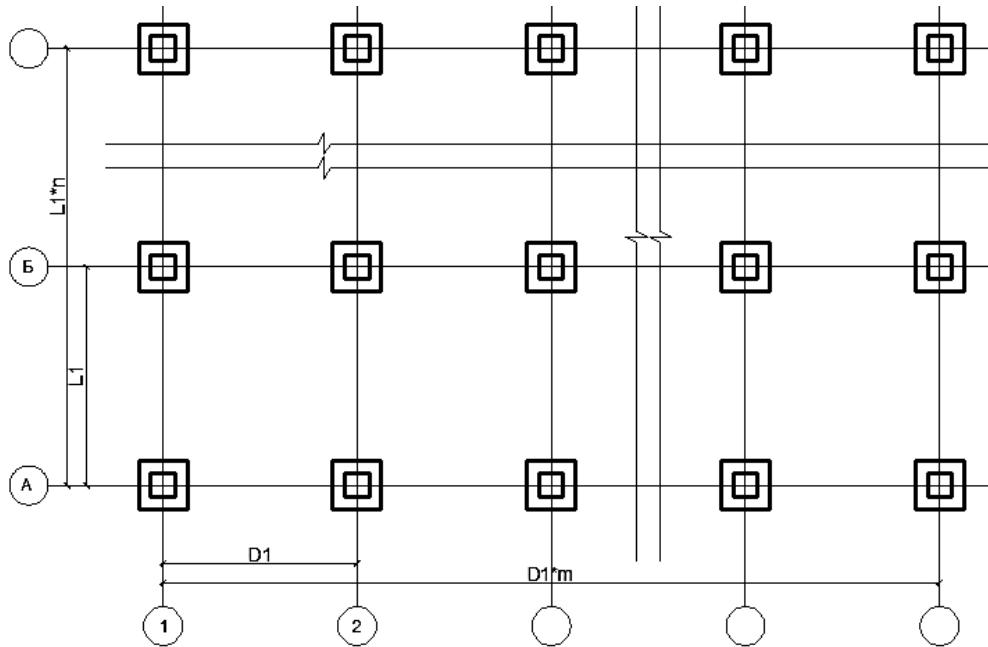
Схеми розташування фундаментів каркасної будівлі для вибору завдання на проектування
